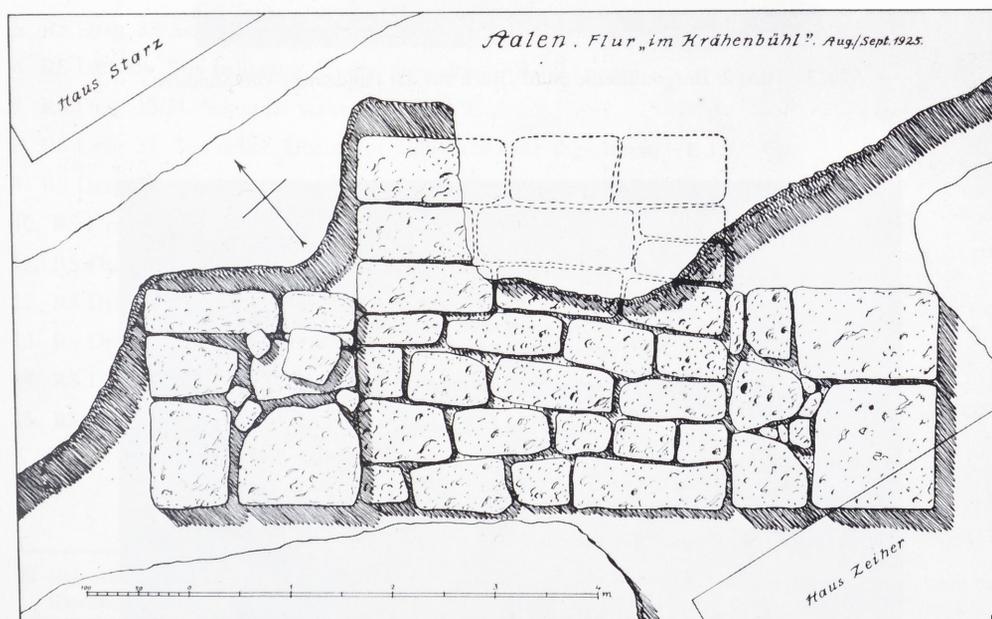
Fdst. 2: Burgstallstraße 30/32. Plan des Fundaments.
